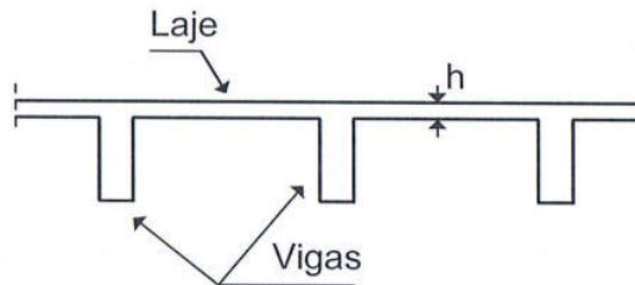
Laje maciça (Fonte: Araújo, 2010)
